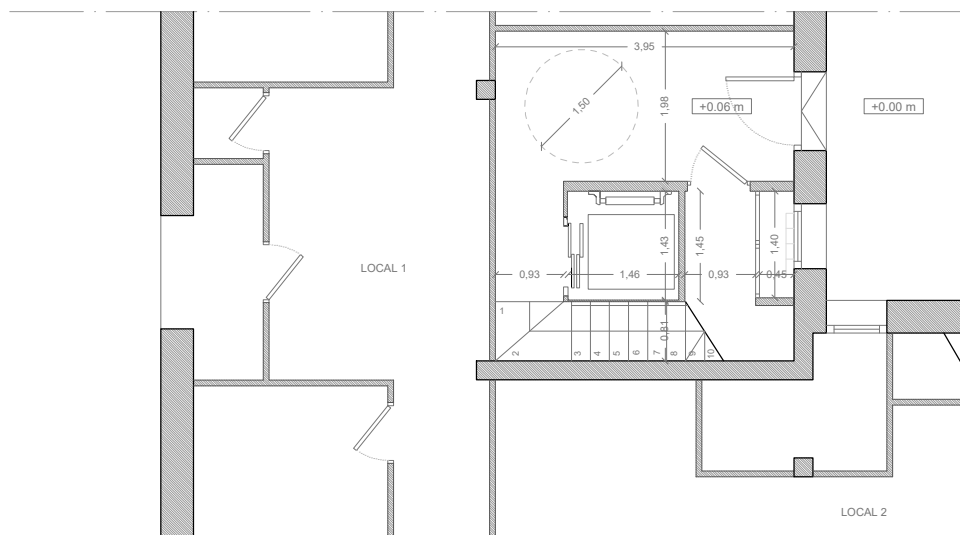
Zoom núcleo planta baja (e: 1/100).
